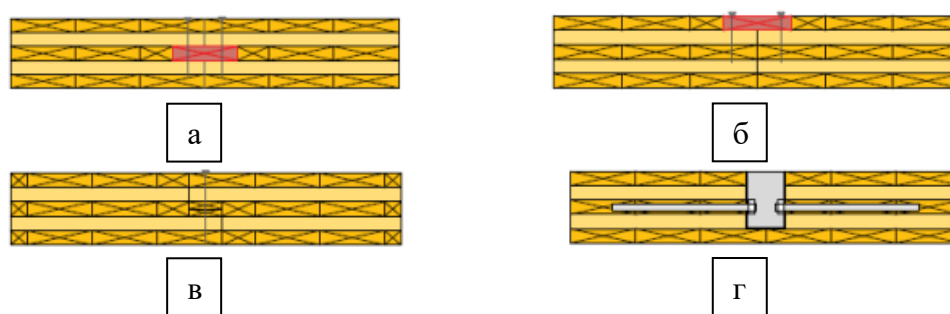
Сопряжение стен из ДПК между собой: а – с использованием потайной соединительной планки; б – с использованием поверхностной соединительной планки; в – пазогребневое соединение; г – с использованием клеенных стержней [200]
